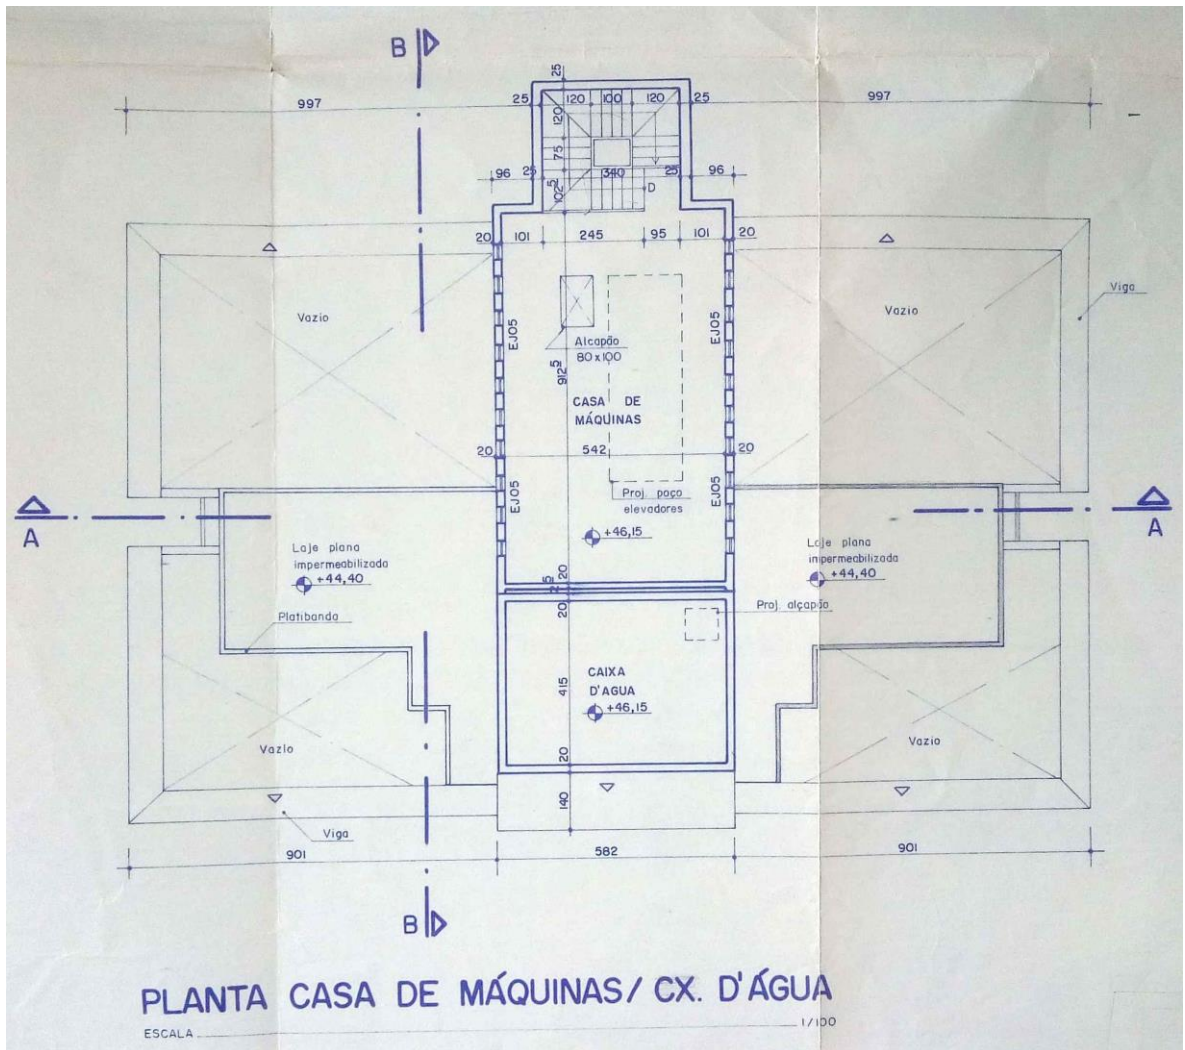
Planta da casa de máquinas e da caixa d'água.
